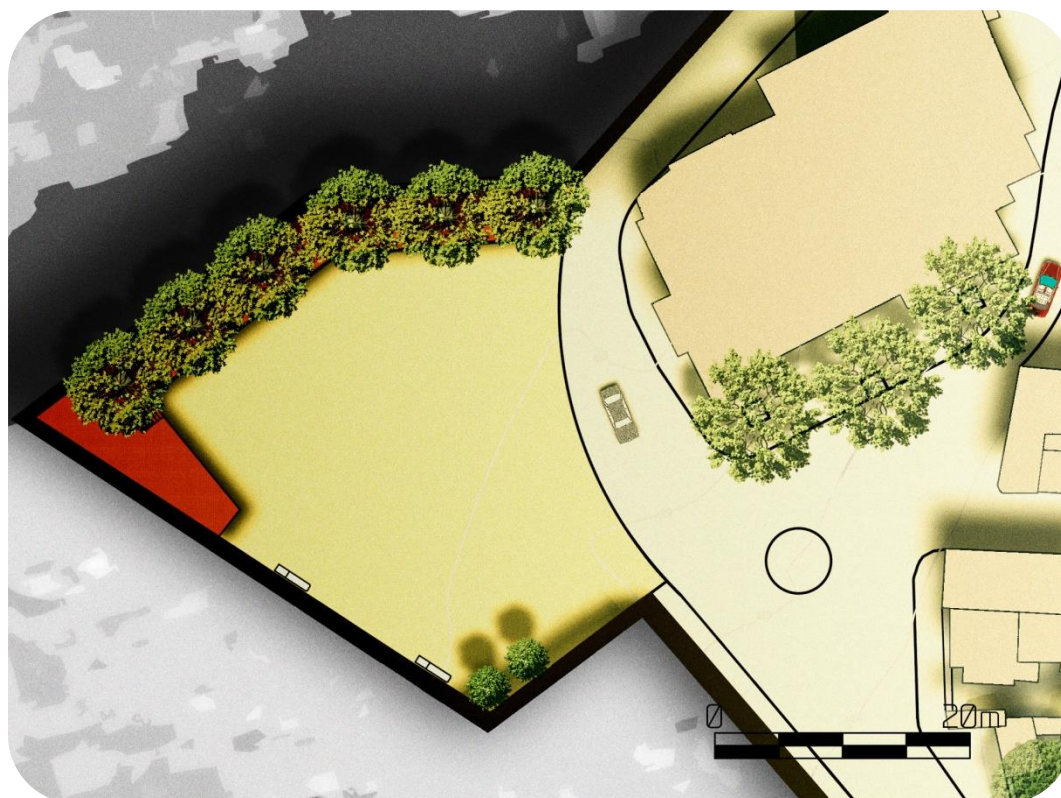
Planta do Baluarte da Nossa Senhora da Saúde
